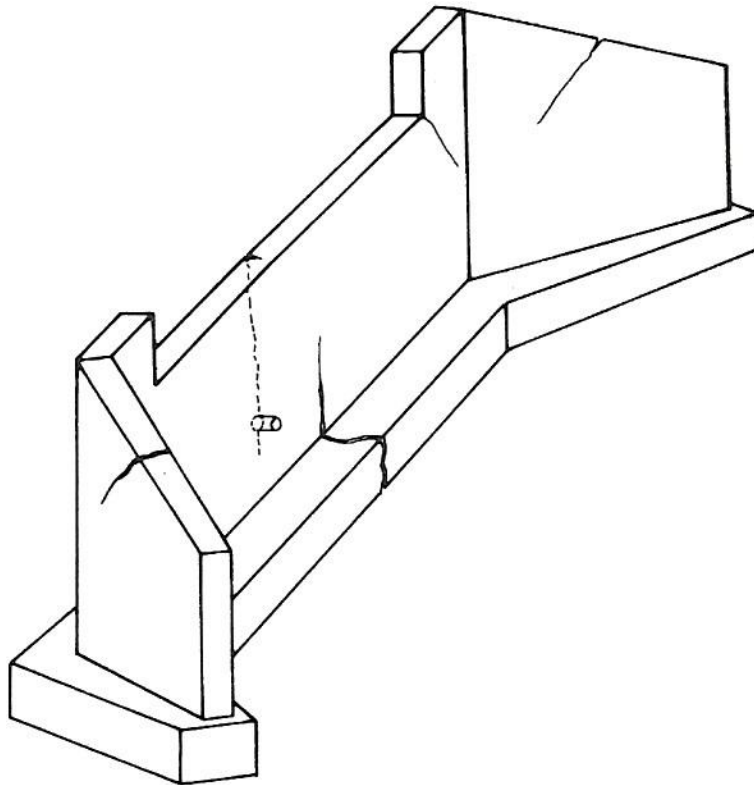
Ocorrência de fissuras em um encontro de concreto armado, provocadas por recalques diferenciais do terreno de fundação. (Fonte: PFEIL, 1983)
